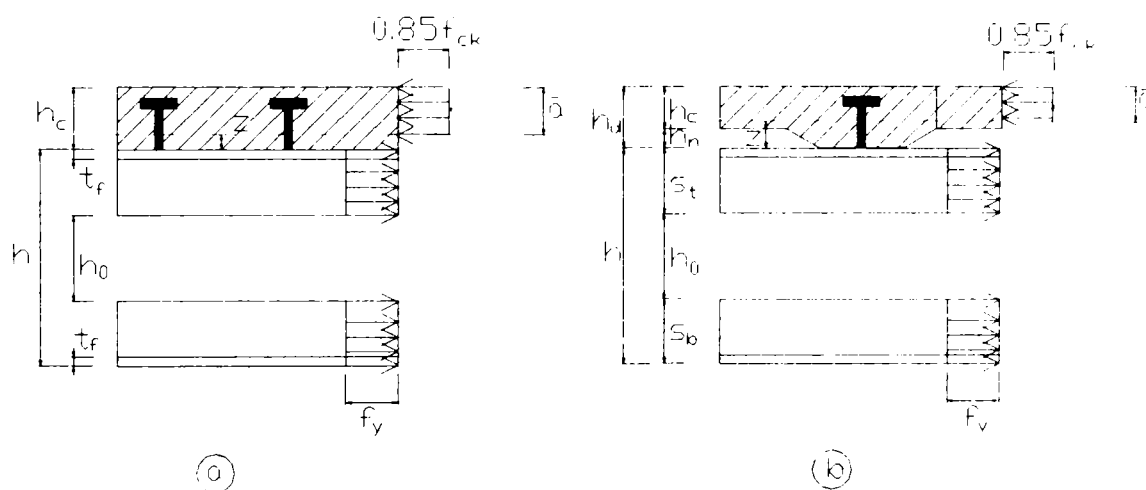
Distribuția eforturilor la grinzi mixte oțel-beton
